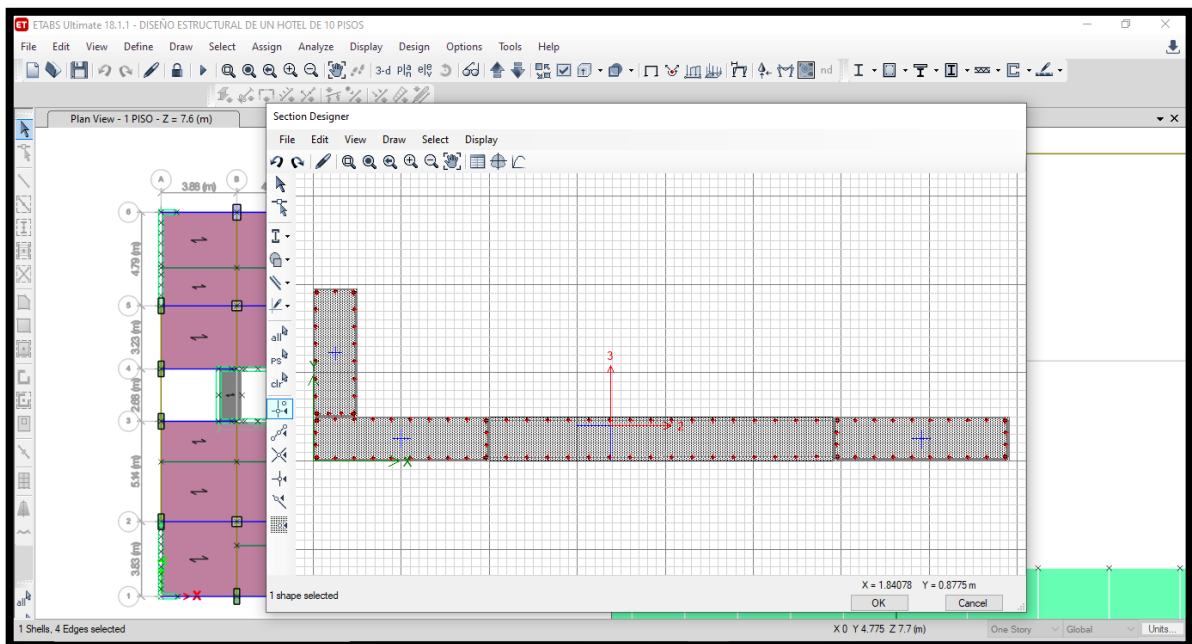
Vista en planta del armado de acero en la sección total de la PL - 1.
